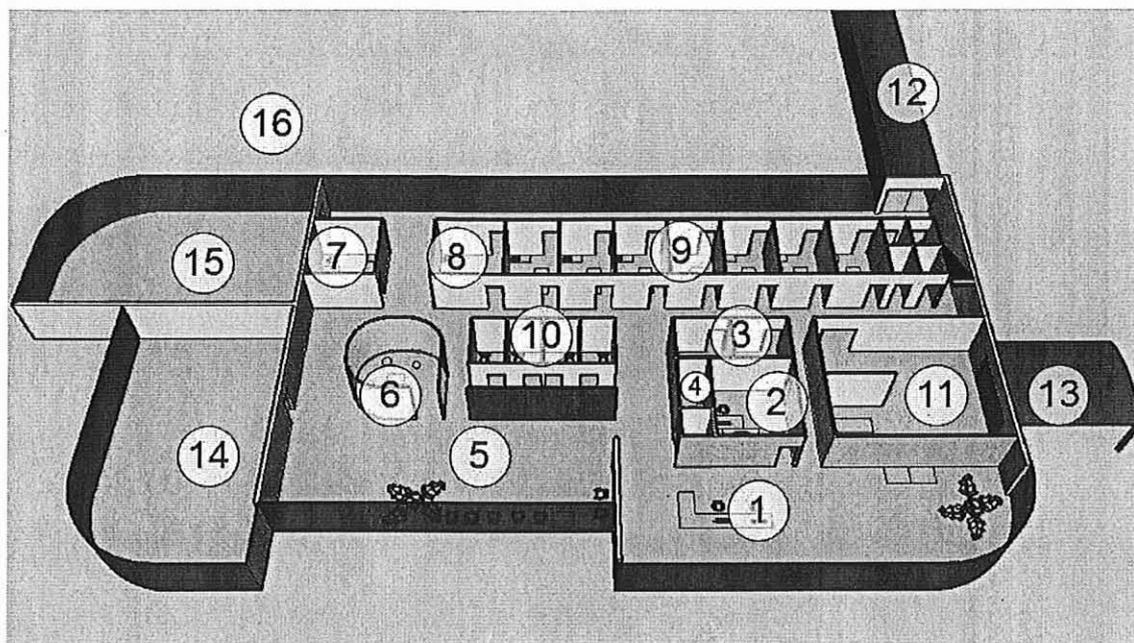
Plan Utopia – RDC de la maison de soins. Plan par Alan Charissou. Modélisation 3D par Alexandre Mauvais
